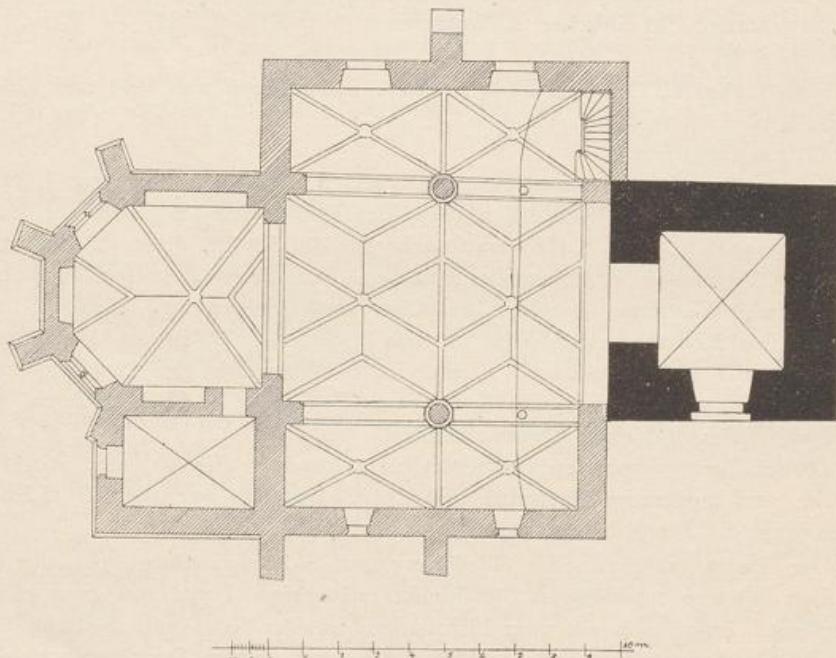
Schoenau. Grundriss der kathol. Pfarrkirche vor der Erweiterung.
